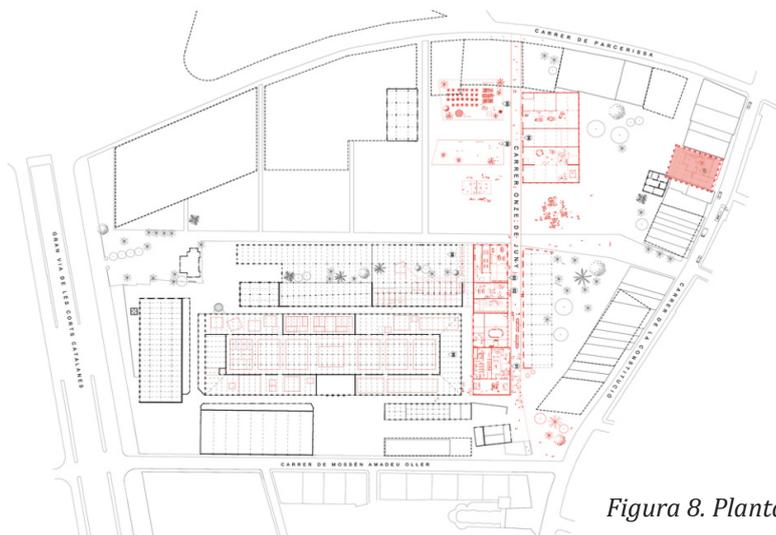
Planta Can Batlló. Figura 9. Axonometría de La Borda.
